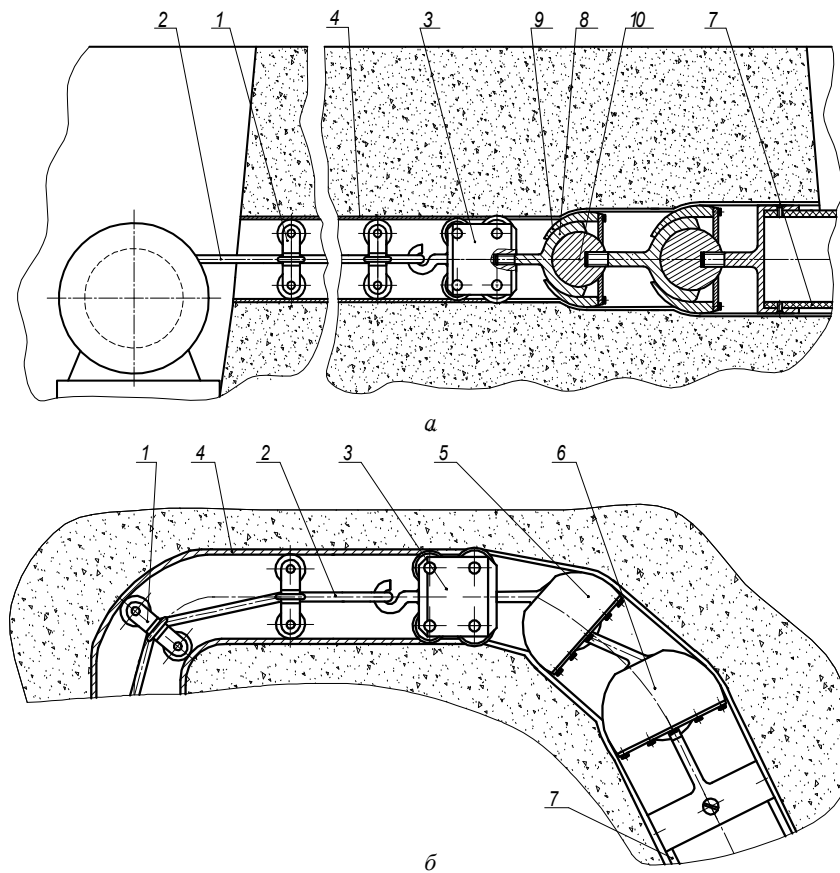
Рабочий орган для бестраншейного ремонта криволинейных трубопроводов при прохождении: *а* – прямолинейного участка, *б* – поворота; 1 – крестовина; 2 – трос; 3 – режущая головка; 4 – старый трубопровод; 5, 6 – расширители; 7 – новый пластмассовый трубопровод; 8 – внутренняя полусфера; 9 – внешняя полая полусфера; 10 – шар
